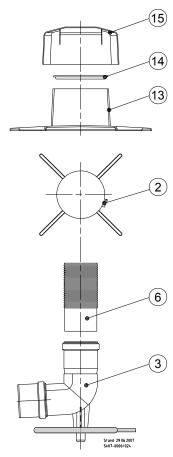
Detail-Zeichnung Befestigung Schachtabdeckung
